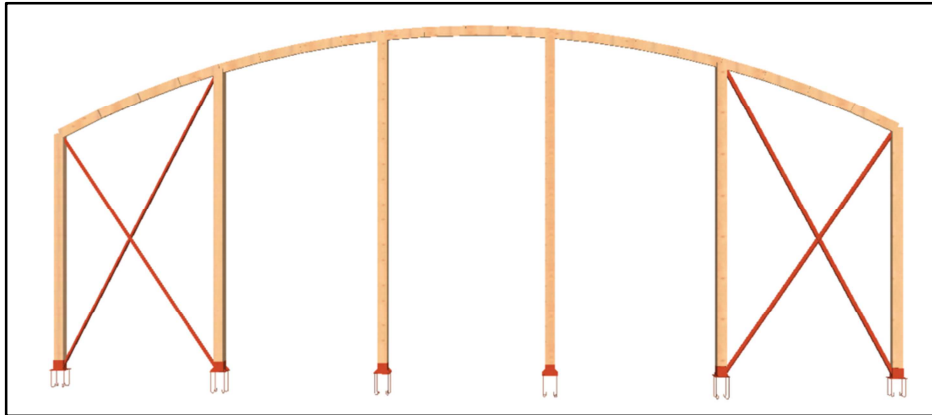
CSA Fachada. Fuente: CYPE 3D.
